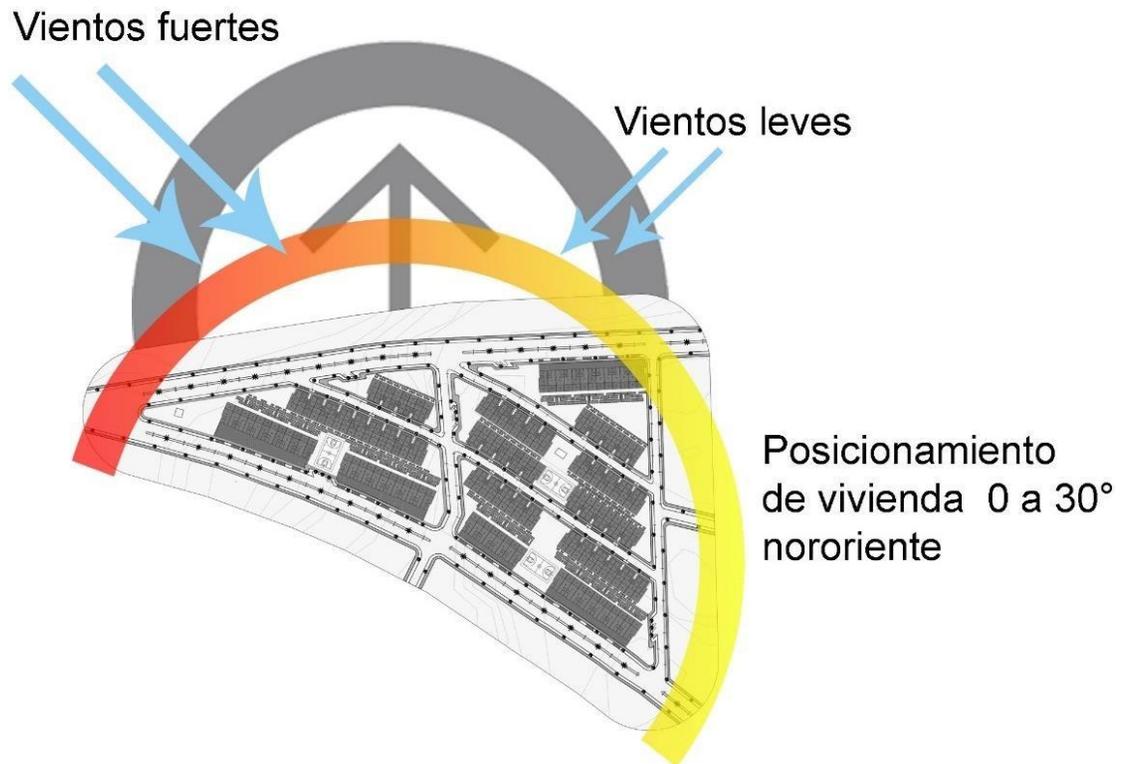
Bioclimática del proyecto. Elaboración Propia
